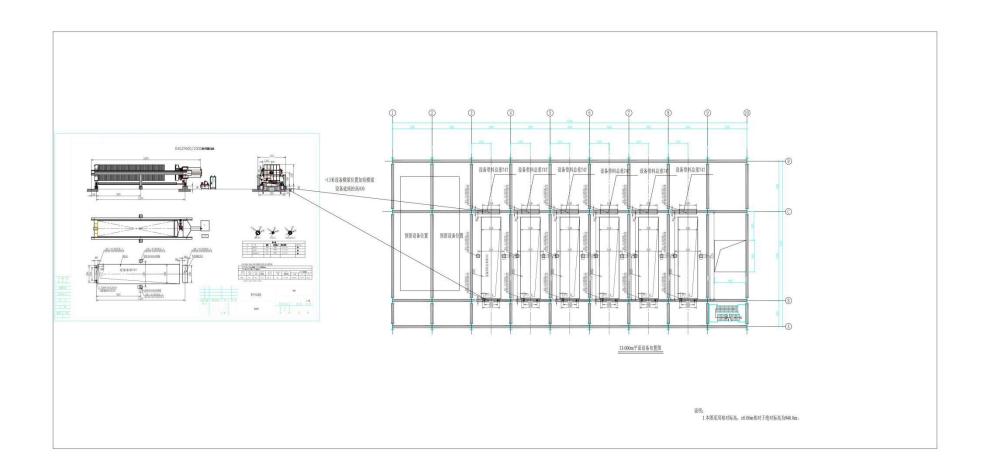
(2) 本项赤泥堆场压滤车间二层平面布置图
